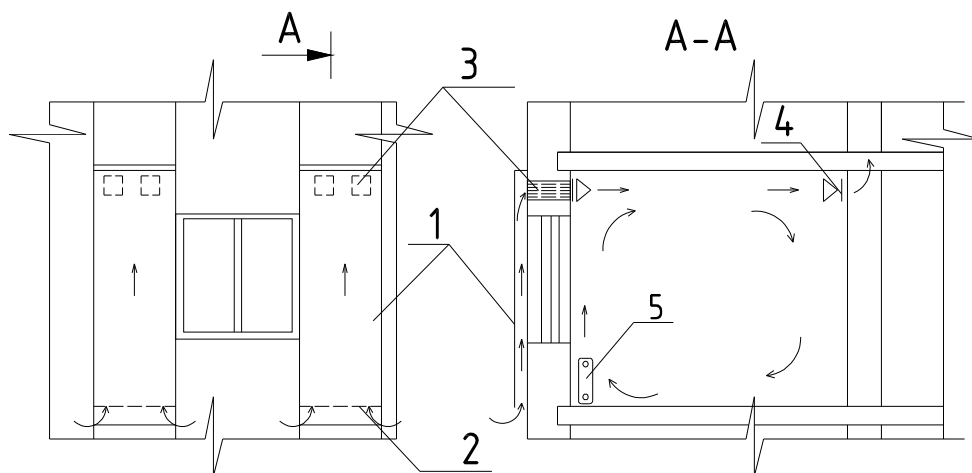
Устройство фасада здания с рекуперативными приточными вентиляционными блоками: 1- навесной фасад; 2 – щелевые зазоры; 3 - вентиляционное приточное устройство типа РПВЭ; 4 – вытяжная решетка; 5- отопительный прибор
